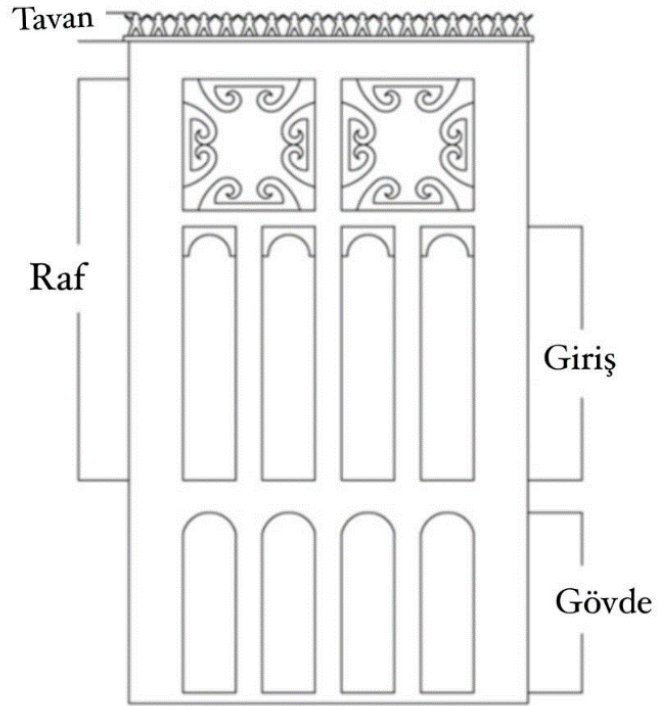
Rüzgar Kulesi Yapısı Plan Örneği
